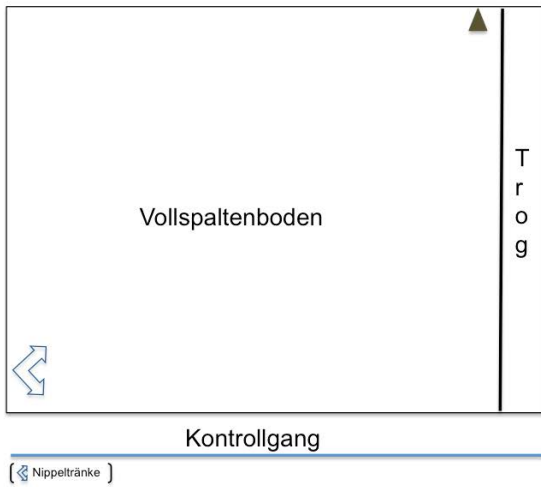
Grundriss des Ferkelaufzuchtsteiles mit den Modell- und Kontrollbuchten
